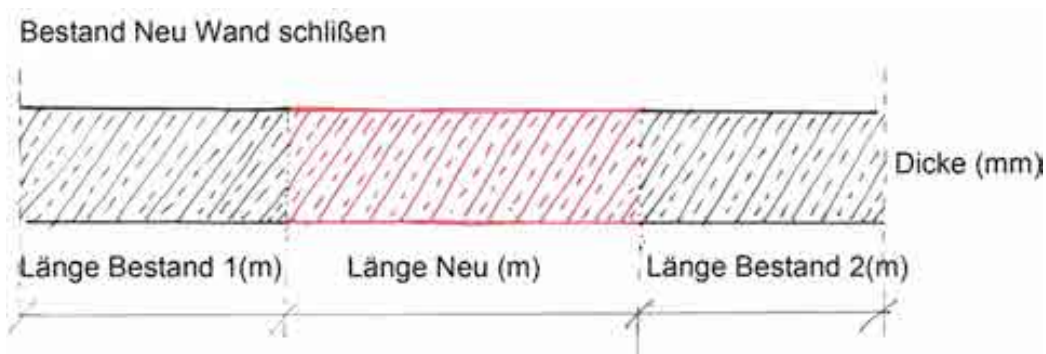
Wand Öffnung Schließen, Bestand und Neu Stahlbeton
